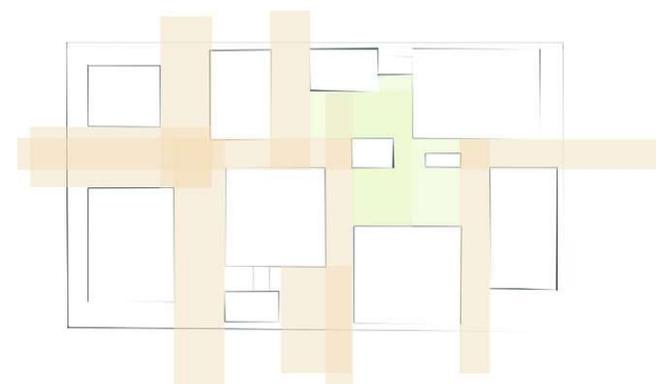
Grundriss Moriyama House mit öffentlichen und privaten Flächen im Außenbereich
